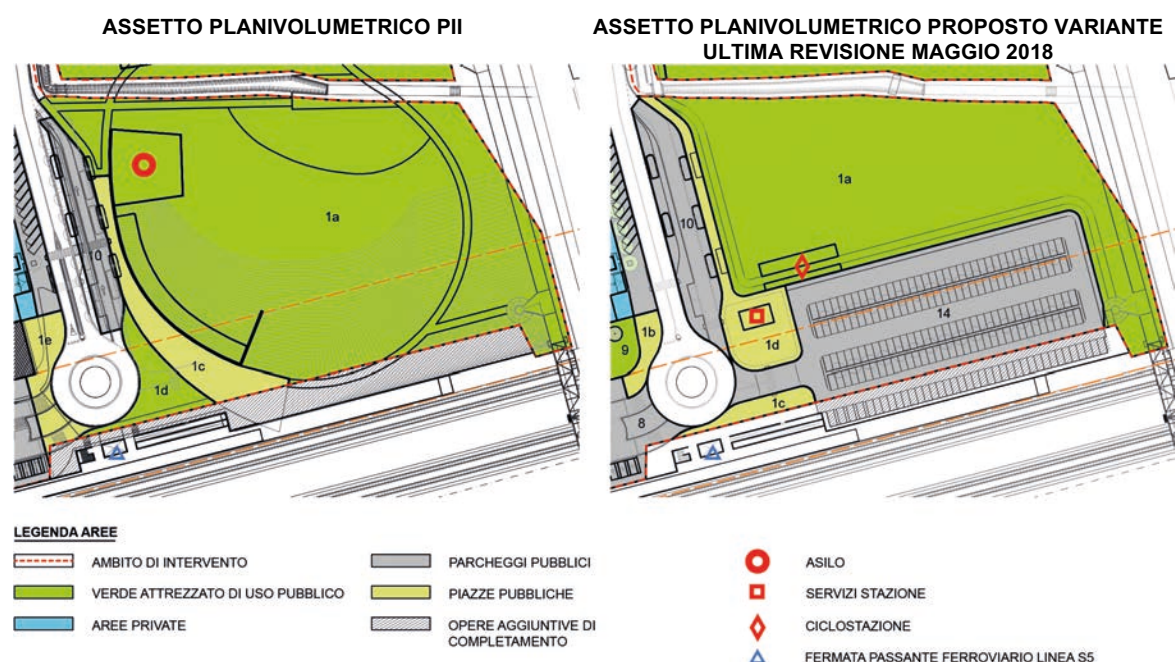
| Confronto tra la planimetria di PII e variante ultima revisione maggio 2018.
